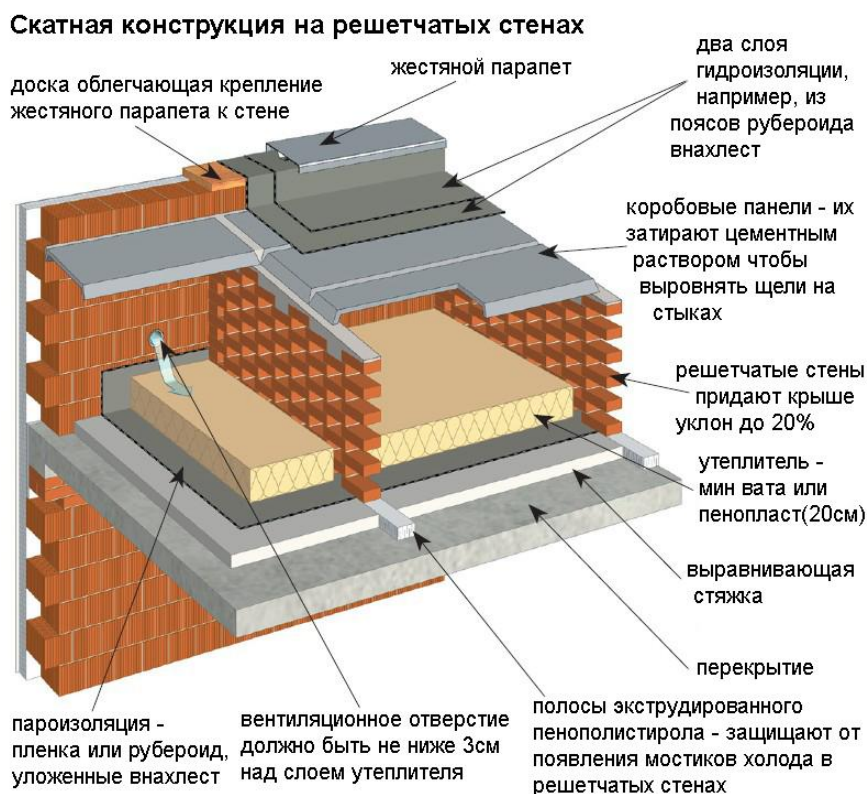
Вариант вентилируемой кровли с решетчатыми опорными стенками
